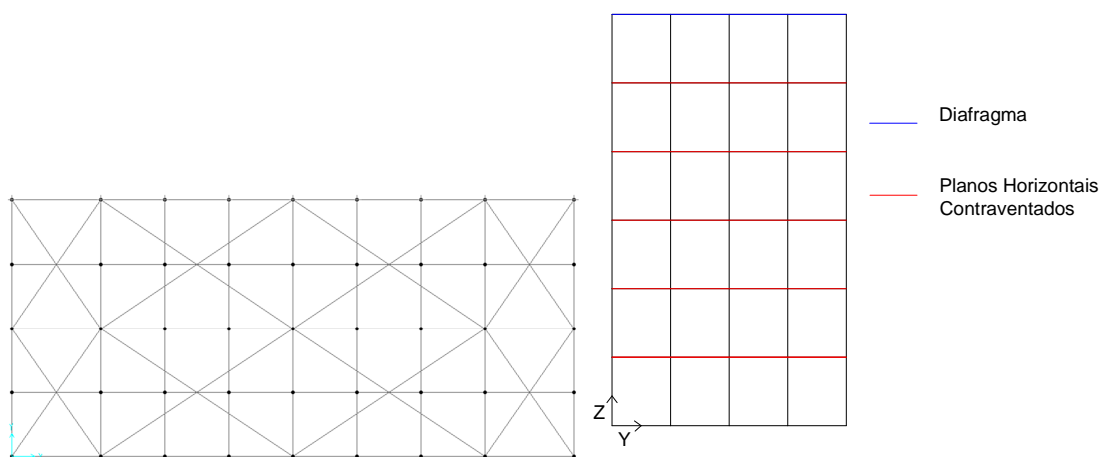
Configuração dos Planos de Contraventamento Horizontal Com Elementos de Contraventamento Grandes
